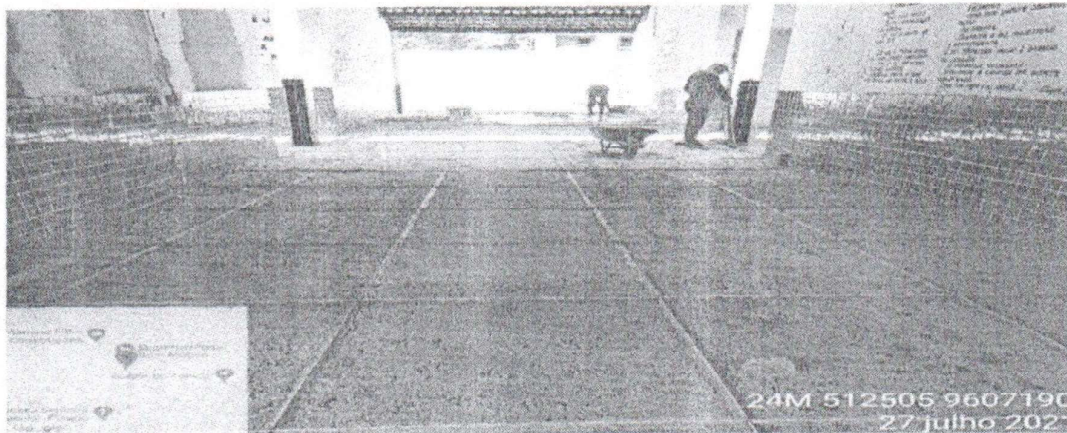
FOTO PRÓPRIA: FITA DE DILATAÇÃO EM CIMA DO LASTRO DE CONCRETO
